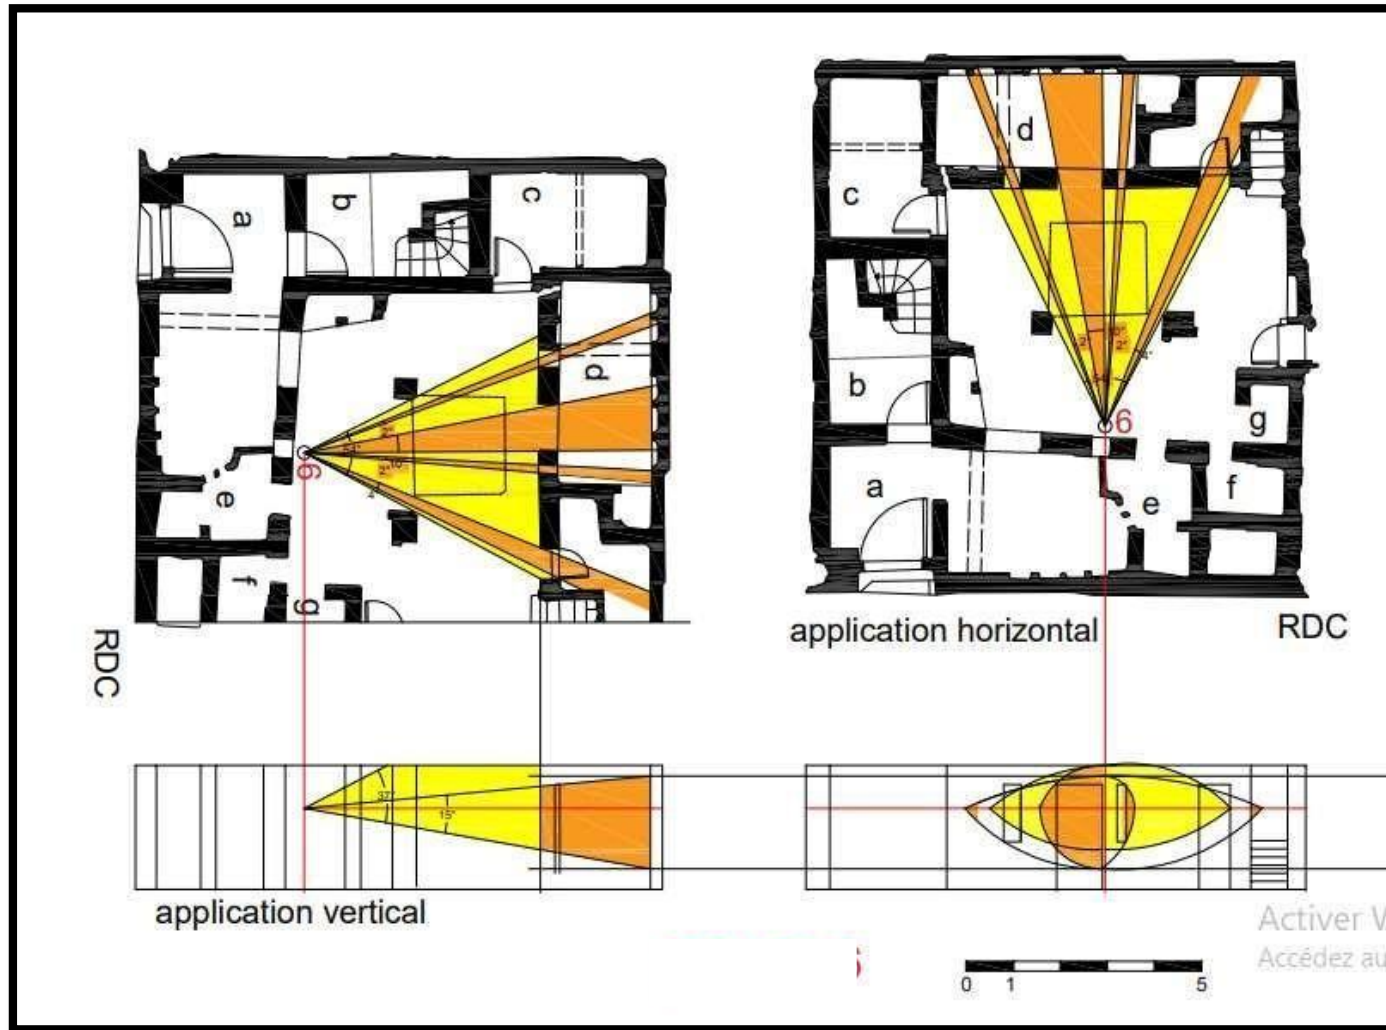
Plan 01 position 06. Source: l'auteur.
